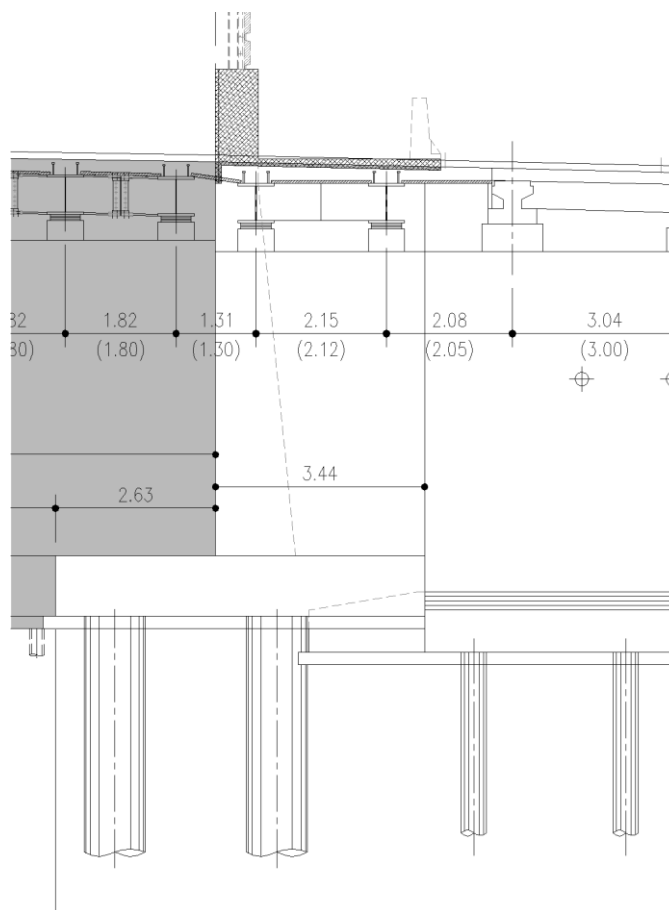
Spalle – Sezione corpo spalla Allargamento 1
